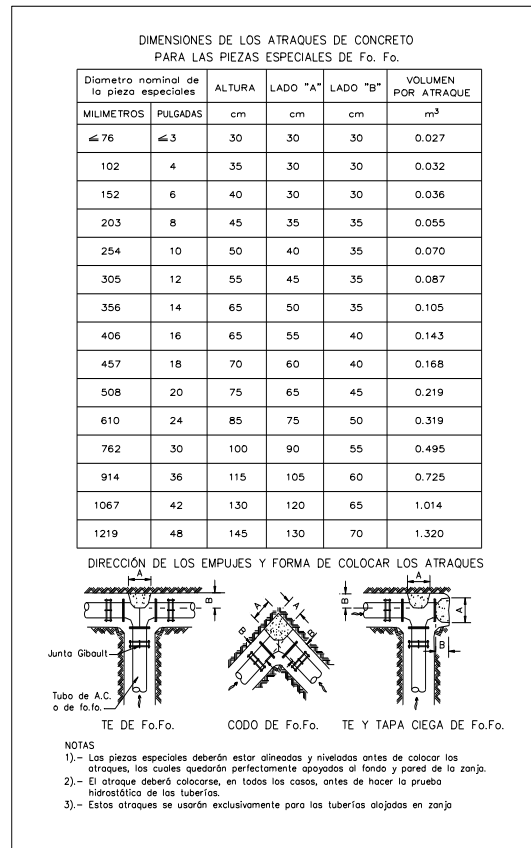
Atraques de concreto para piezas especiales.
